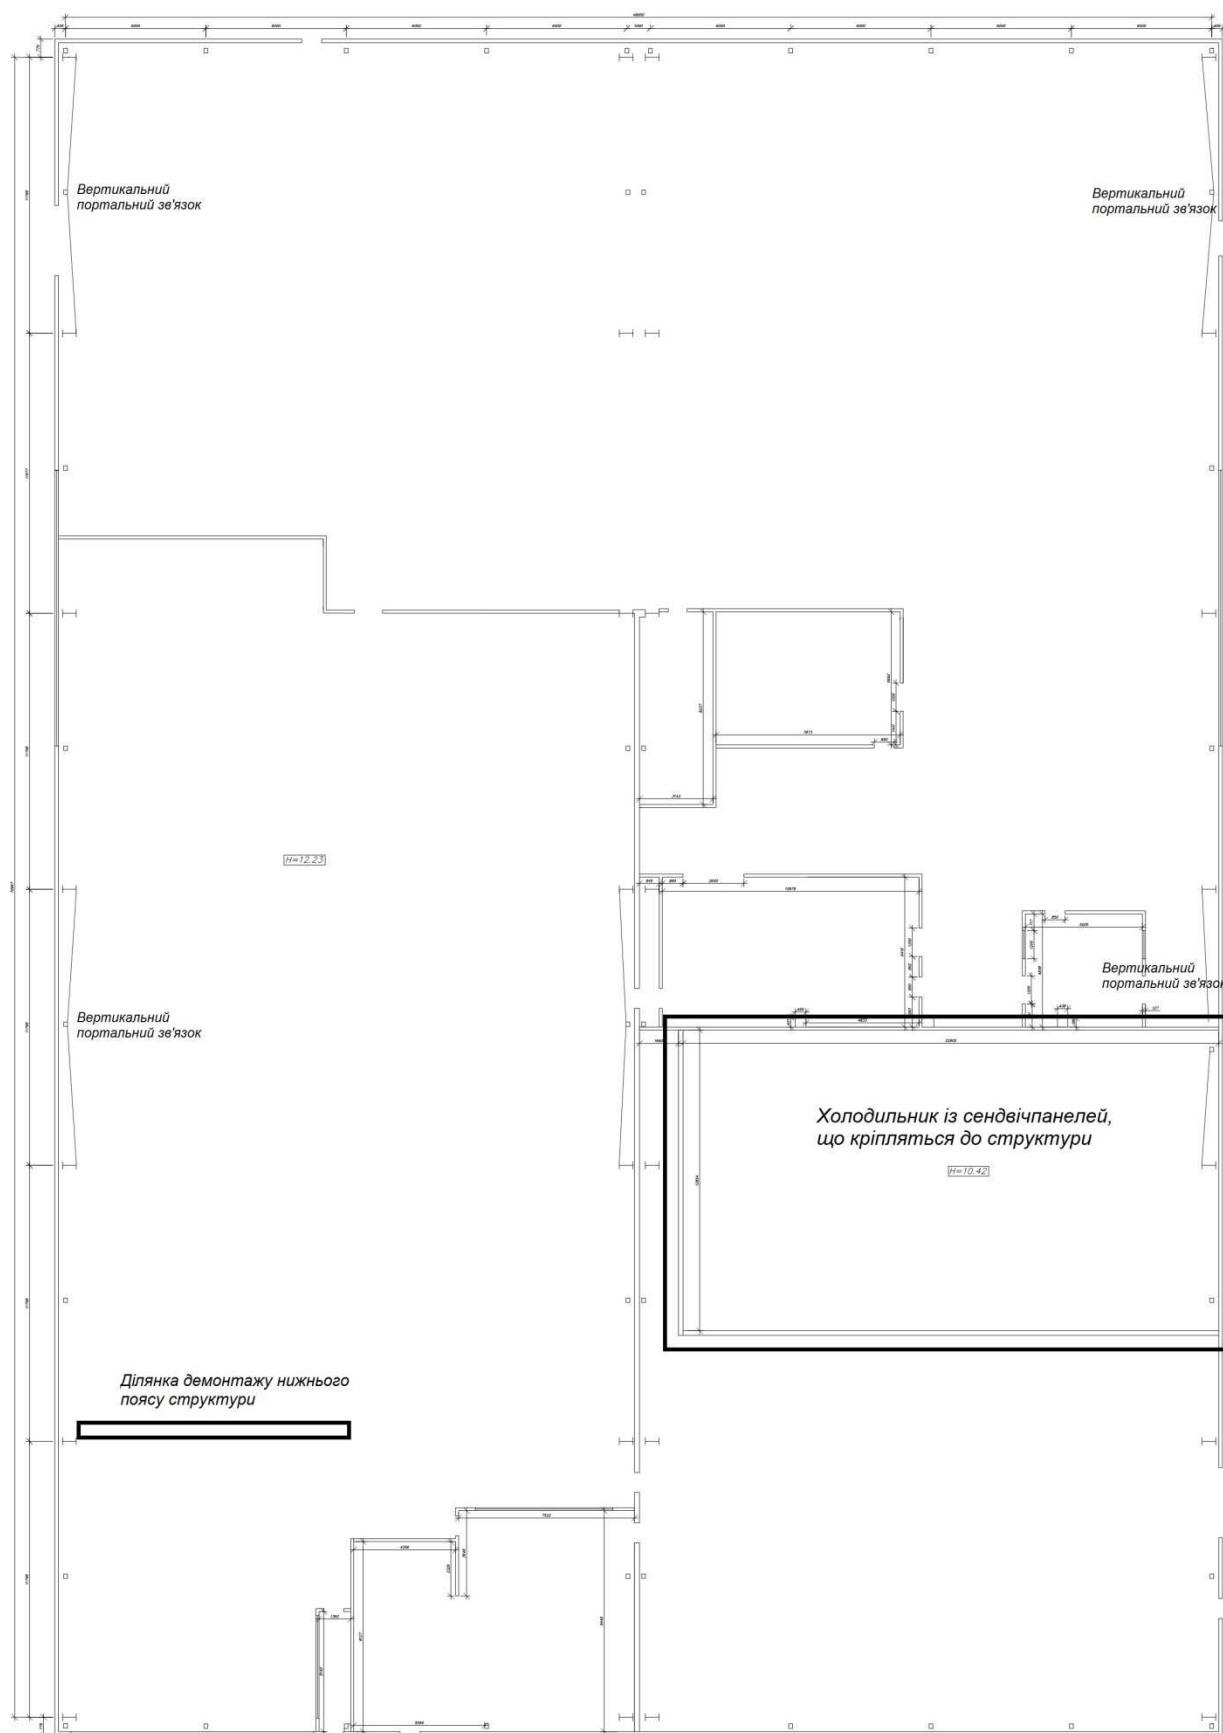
Розташування місця пошкодження структури перекриття та приміщення холодильника на плані 1-го поверху будівлі
